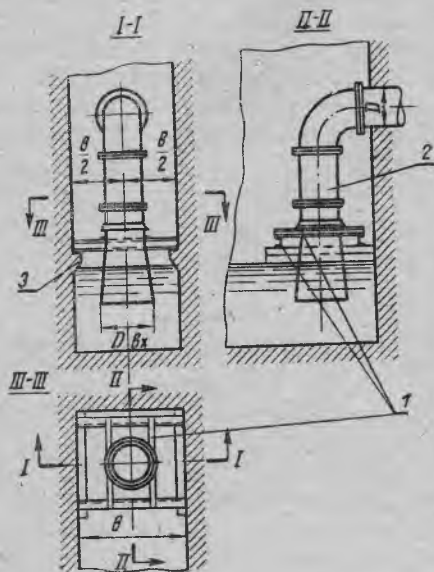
Крепление всасывающей трубы в водоприемной камере на стальной раме:
